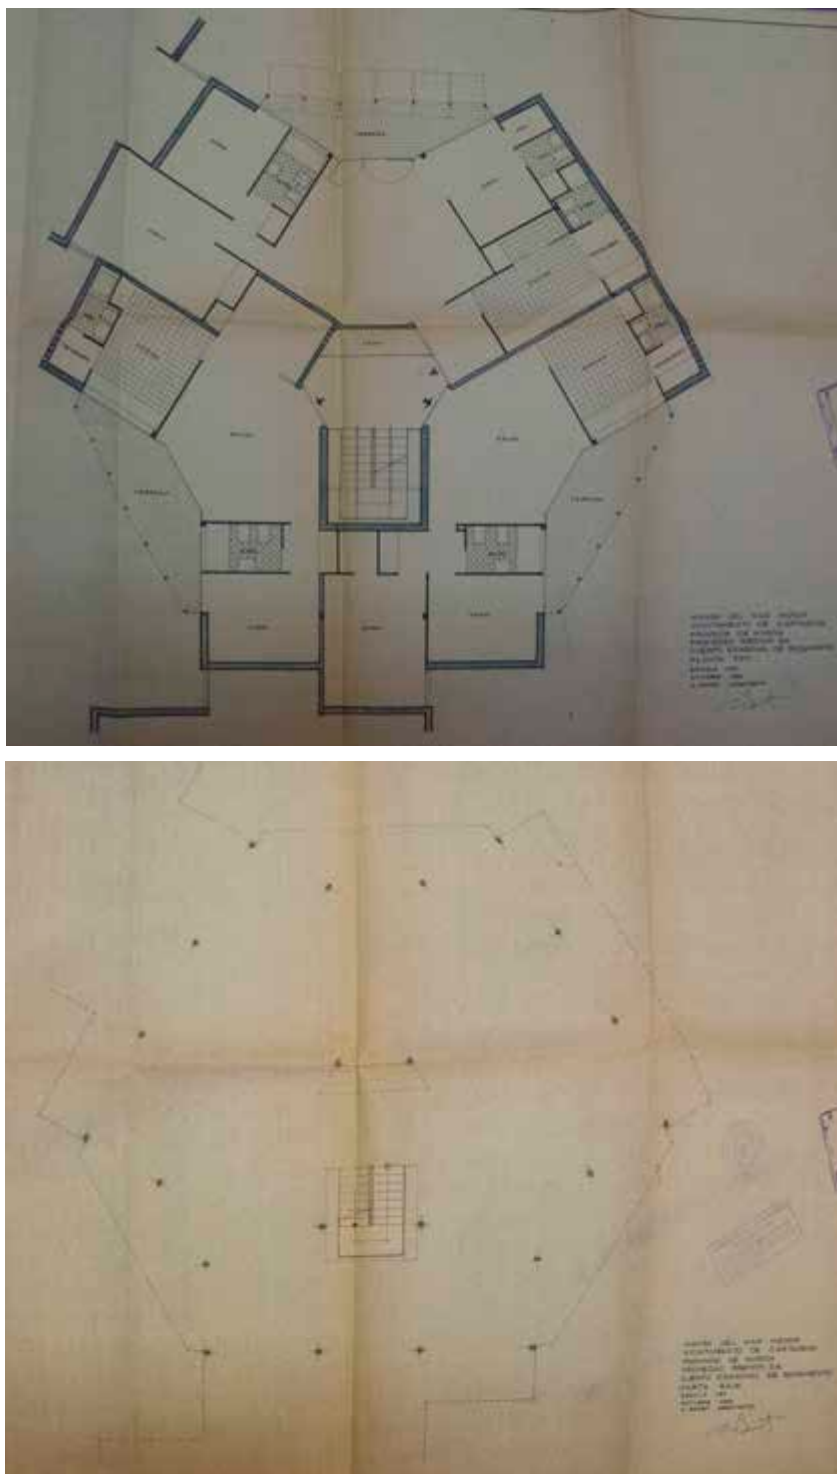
Planos del proyecto original del cuerpo hexagonal de basamento. Arriba, planta tipo, abajo, planta baja. Antonio Bonet Castellana. Escala original 1/50. Fecha octubre de 1963. Fuente: Archivo Municipal de Cartagena.
